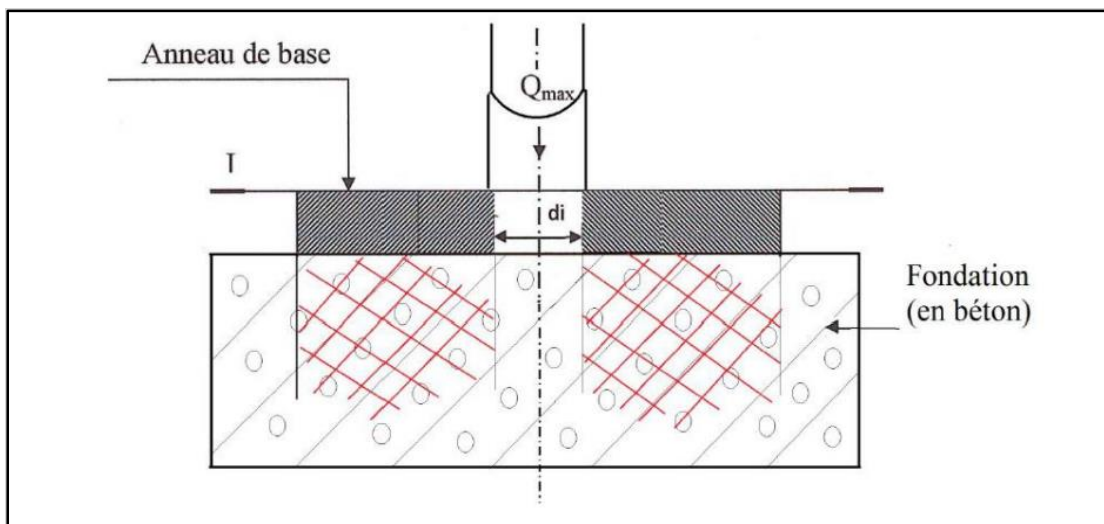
Contrainte agissant sur la fondation d'une colonne
